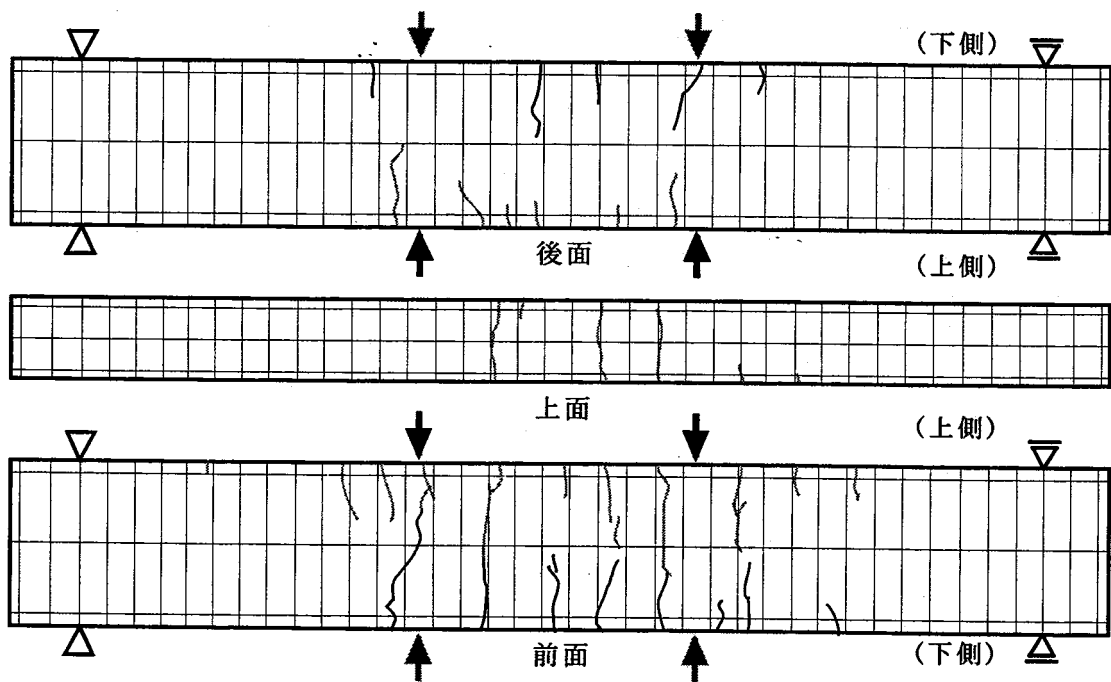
a) ひび割れ性状 [BS-3 ; R = 1/1600rad.]
